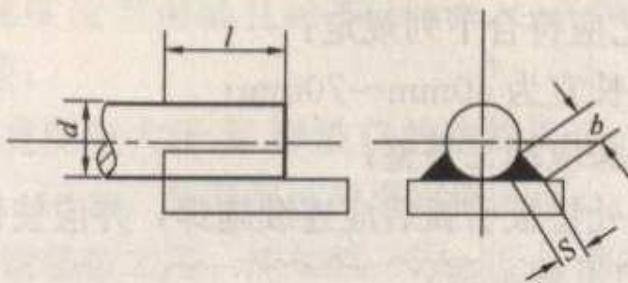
钢筋与钢板搭接焊接头
